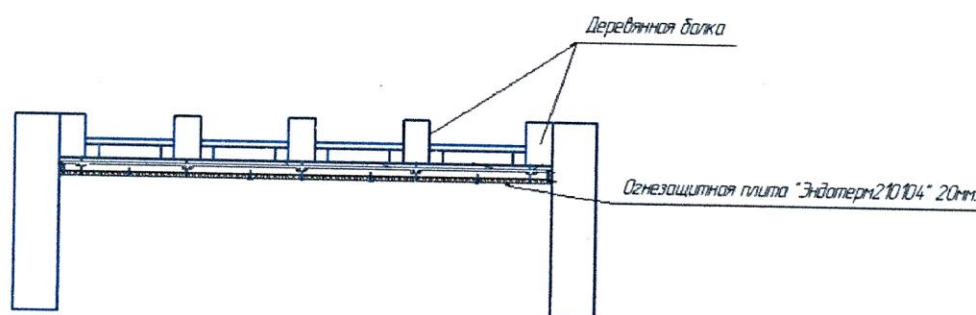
Схема расположения элементов огнезащиты деревянного перекрытия.
